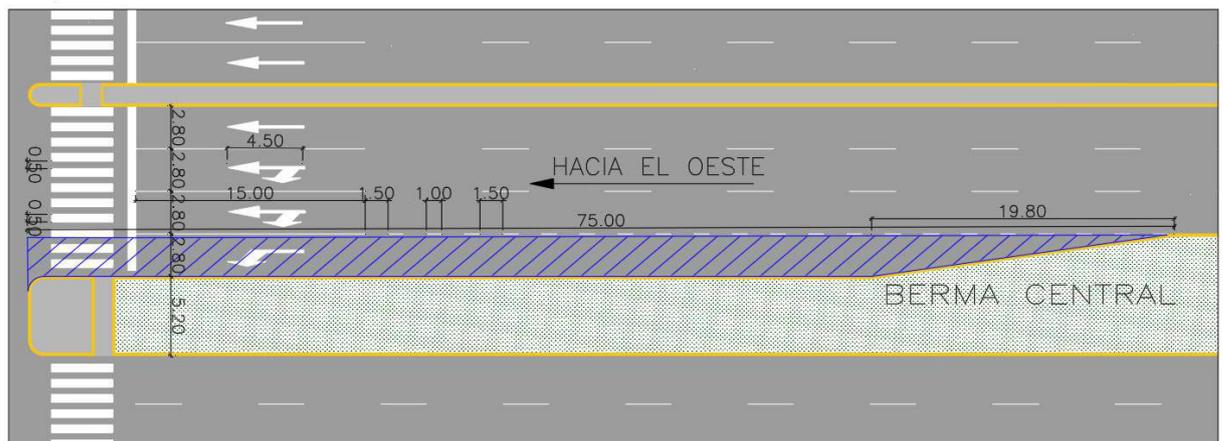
Detalles Carril giro izq. Propuesta – Av. Primavera E – O
